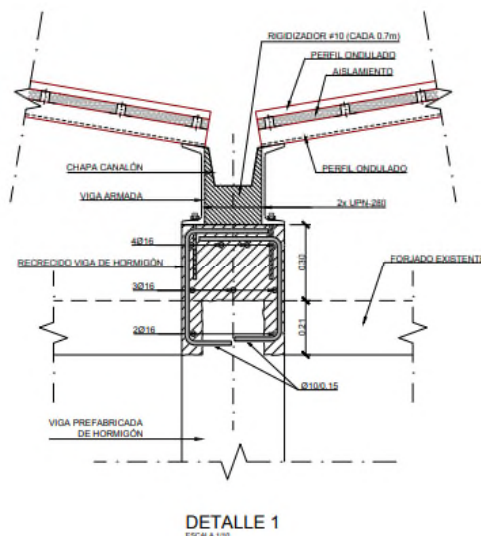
Detalle del apoyo de la cubierta propuesta marcado en el plano anterior
